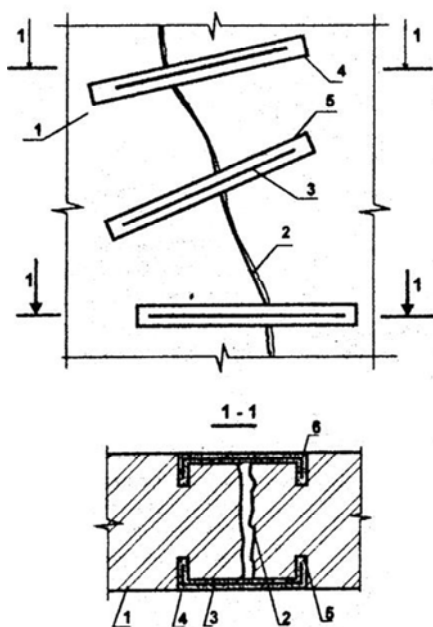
Усиление участков кладки скобами из арматурной стали:
